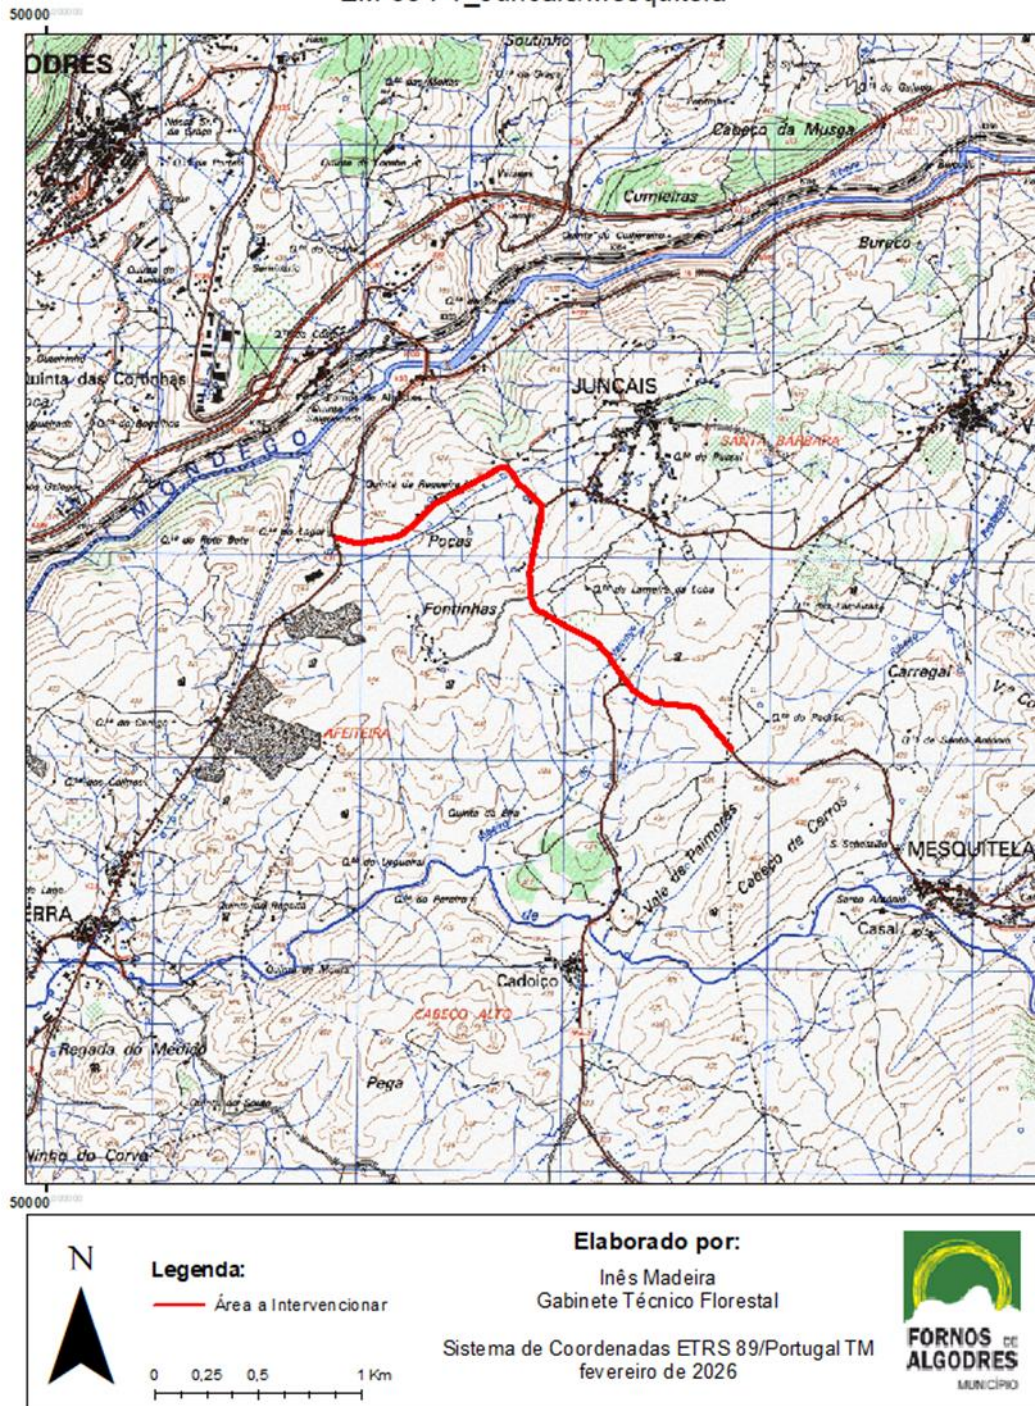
Planta de localização - EM554-1_Juncais/Mesquitela
